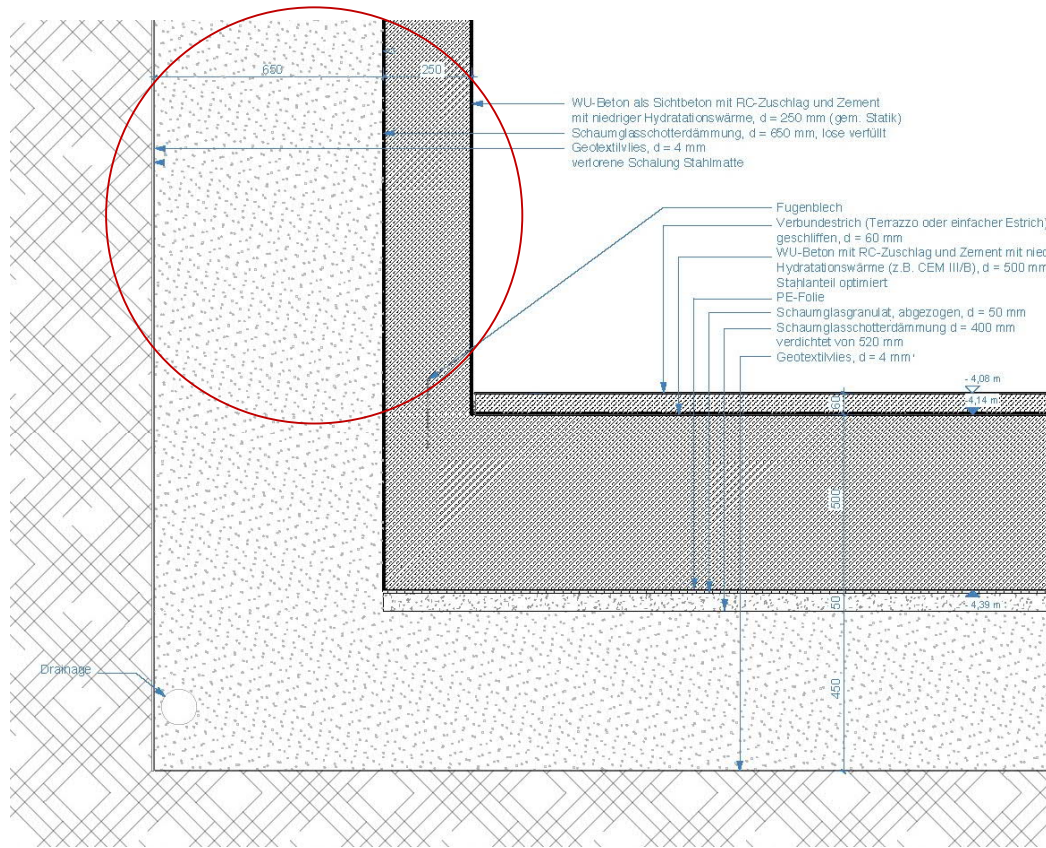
Detail Sockelanschluss / erdberührte Außenwand_optimierte Planung
